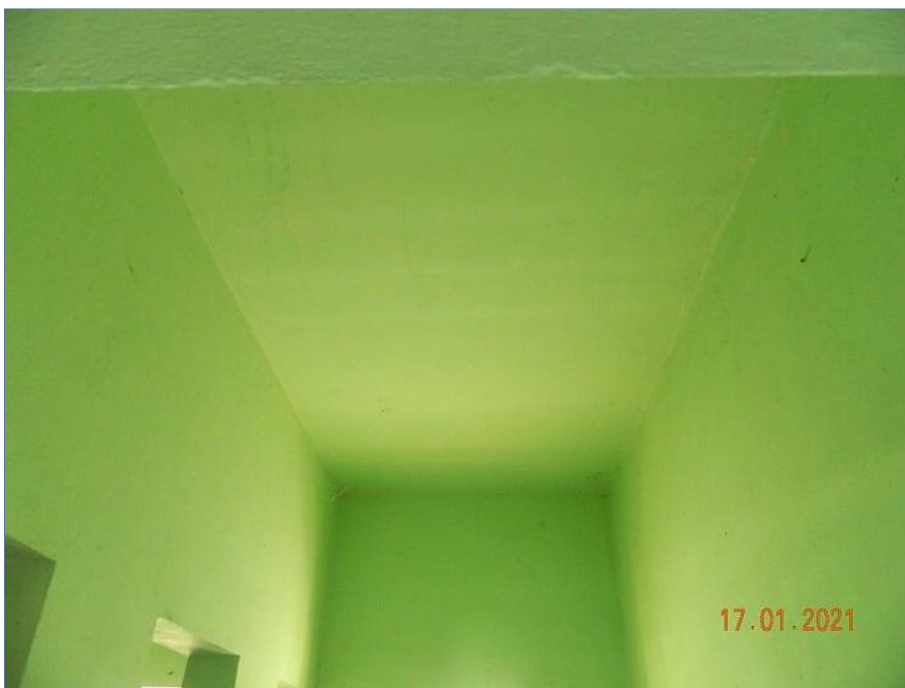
Vista geral: Teto do banheiro masculino.
